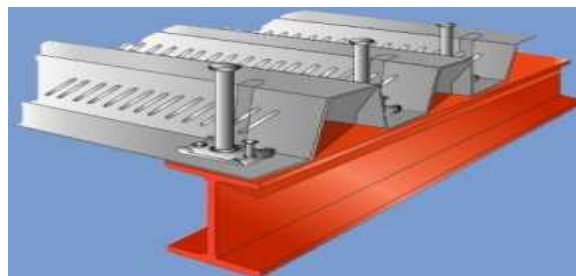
Ligação da viga de aço à laje mista, através de pernos de cabeça.
